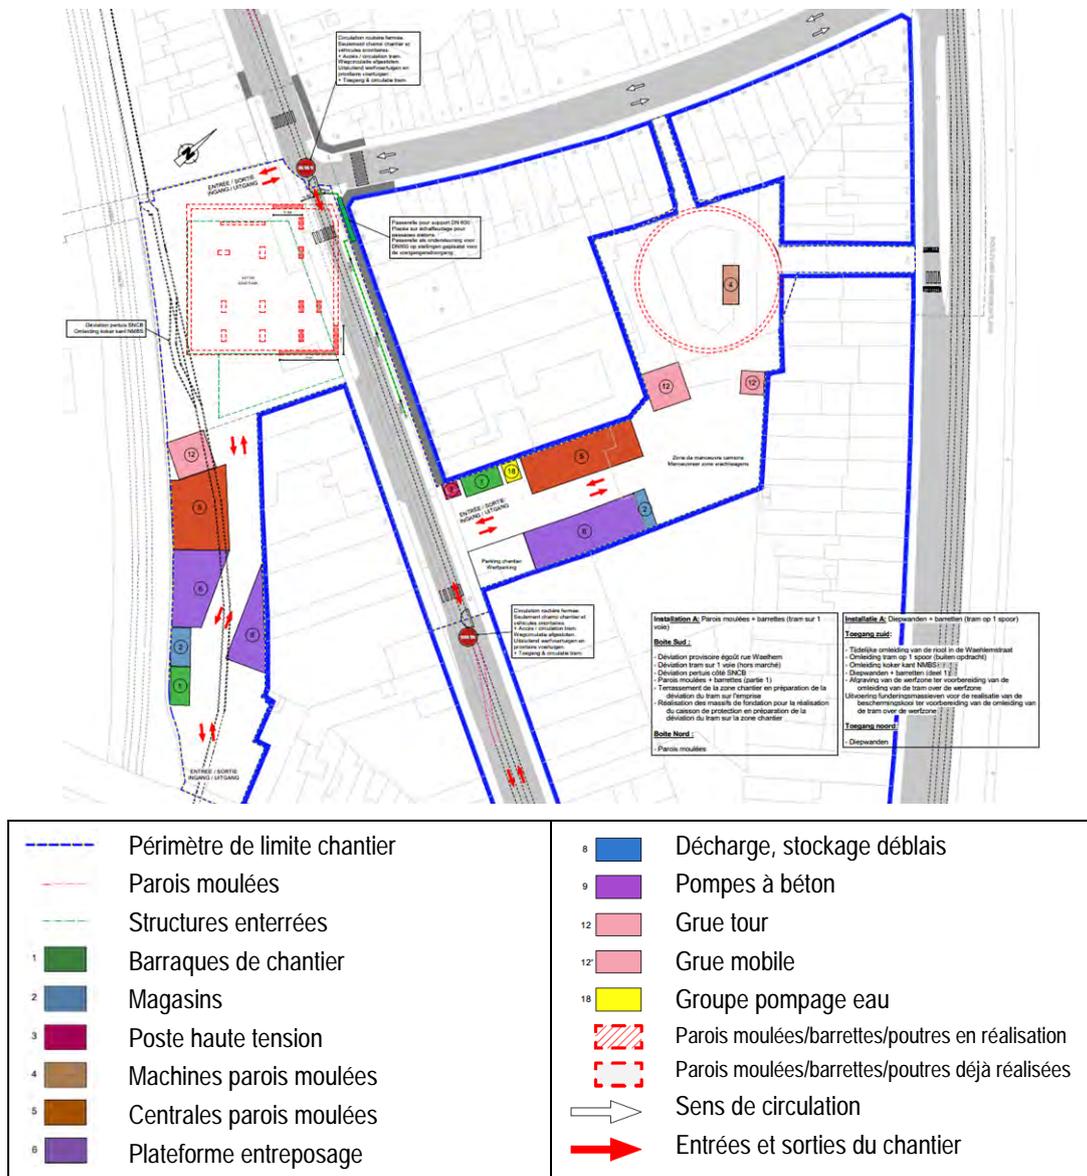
Plan de la phase A des installations de chantier (BMN, 2019)
